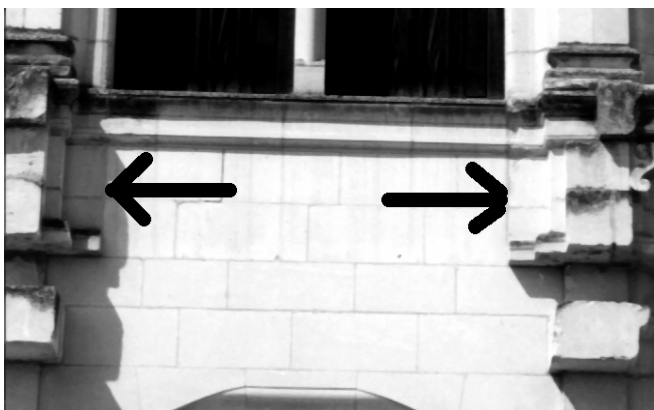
Allège rapportée à la baie centrale au premier étage, façade sud-est.
